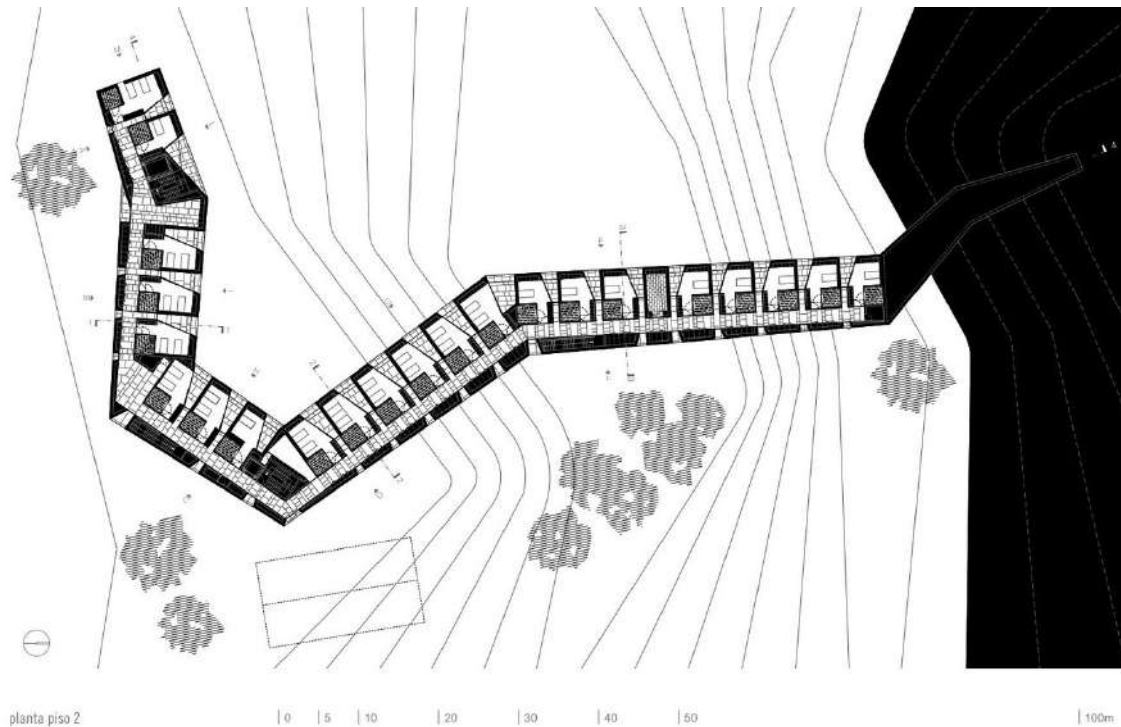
Plano distribución Planta 2. Fuente: www.archidaily.com
